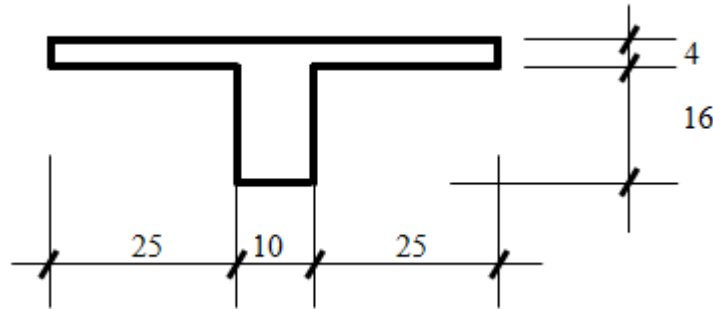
Notations utilisées pour la poutrelle d'un plancher corps creux
